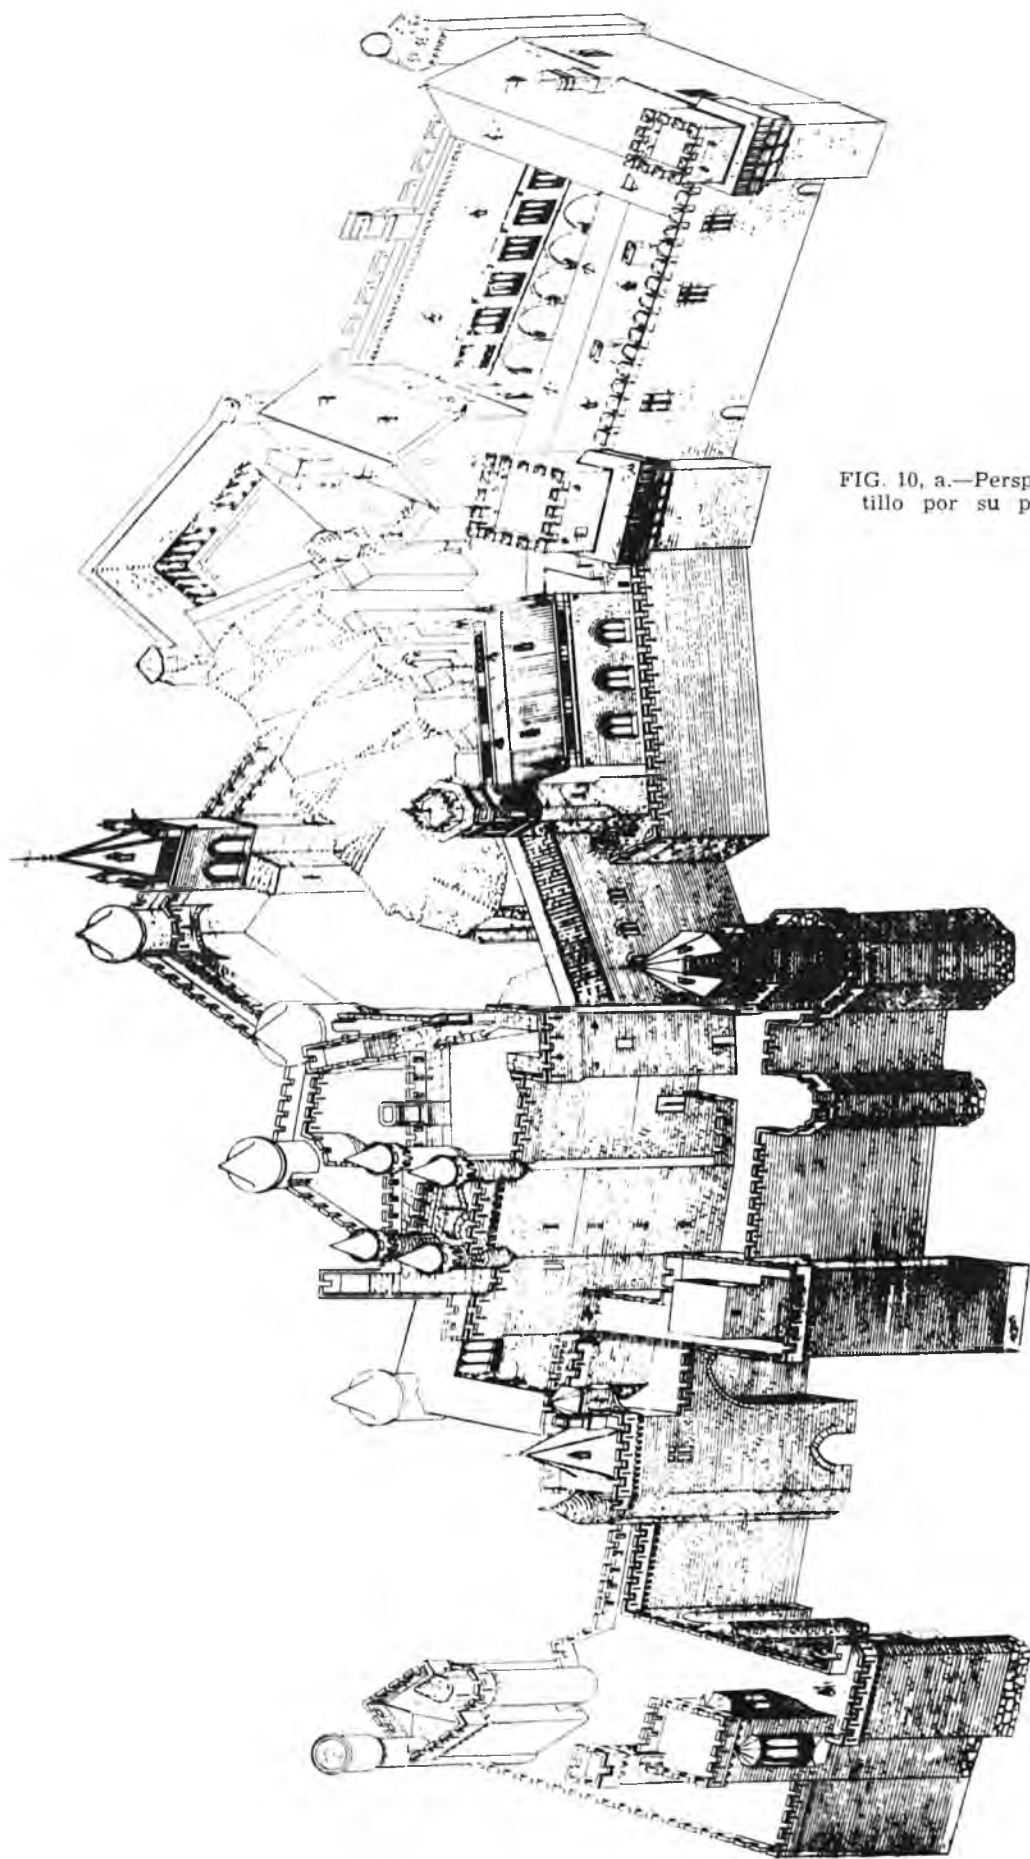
, a.—Perspectiva del castillo por su parte frontal.
